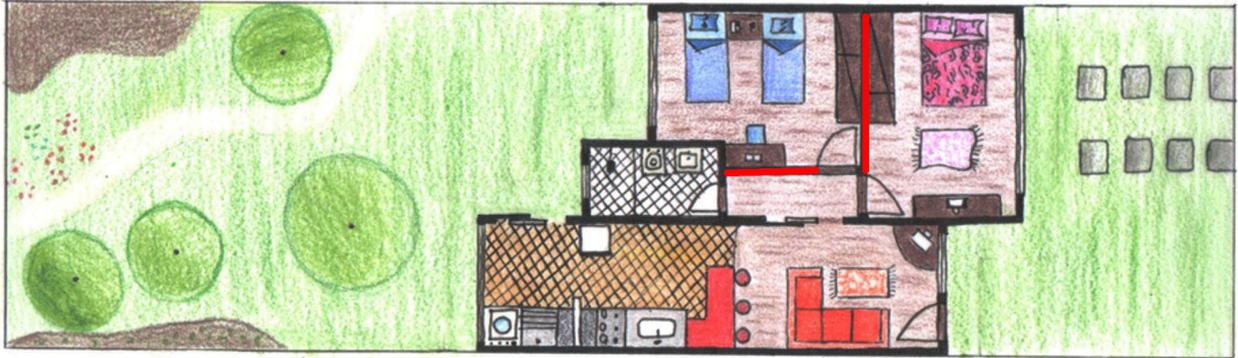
Planta-baixa pavimento térreo modificado. Estudo preliminar.
